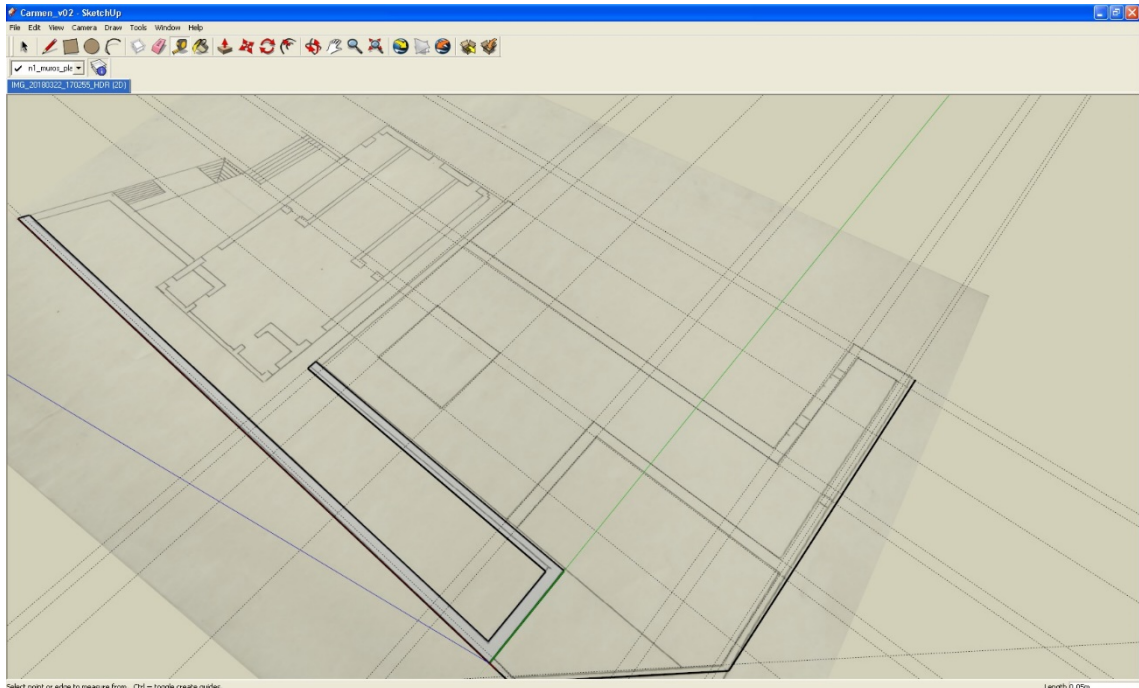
Dibujo de los muros sobre la planta rectificada.
